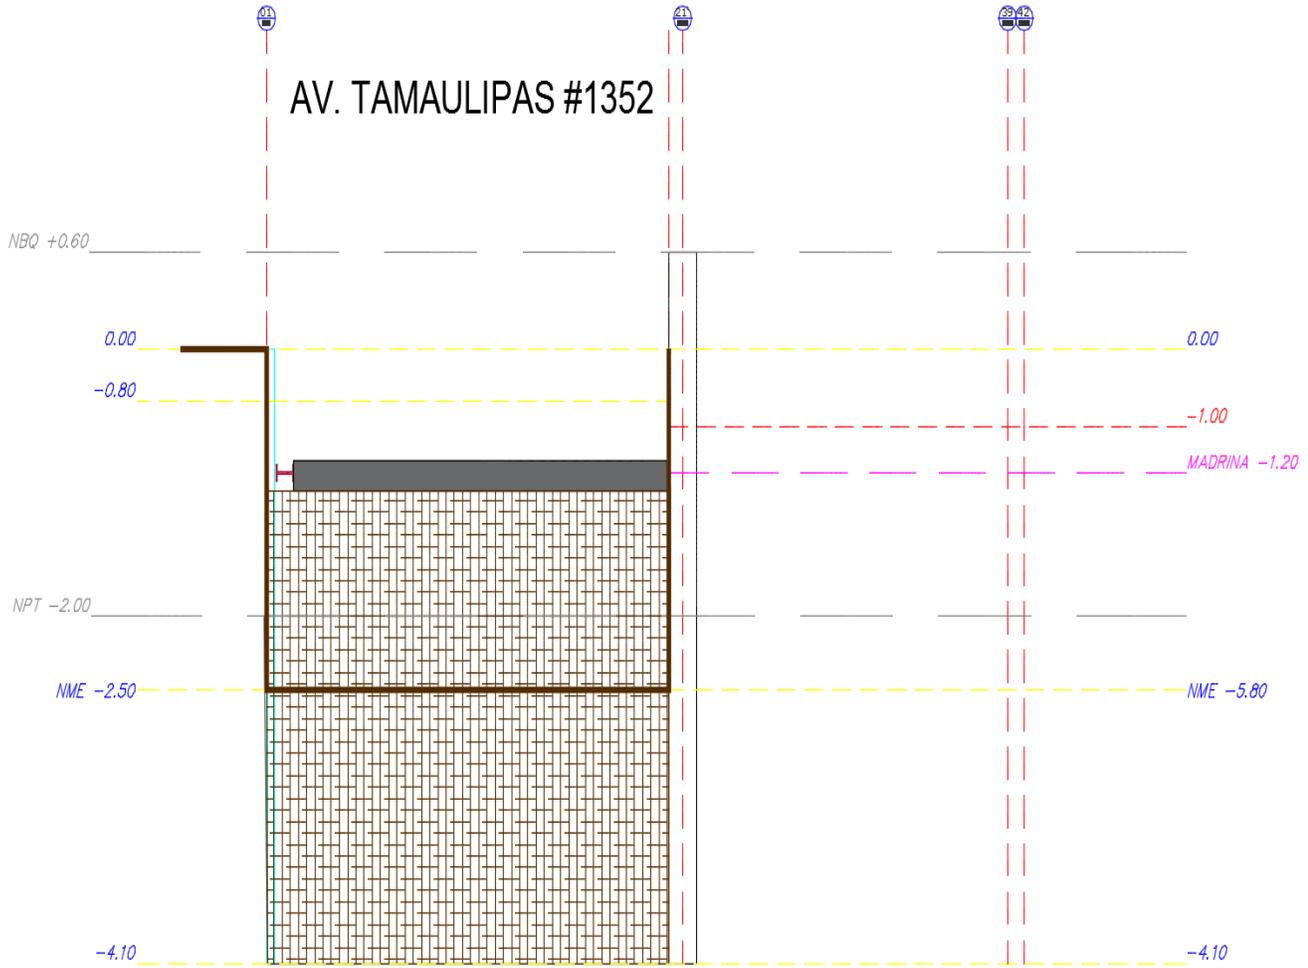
PRIMER NIVEL DE TROQUELES.
